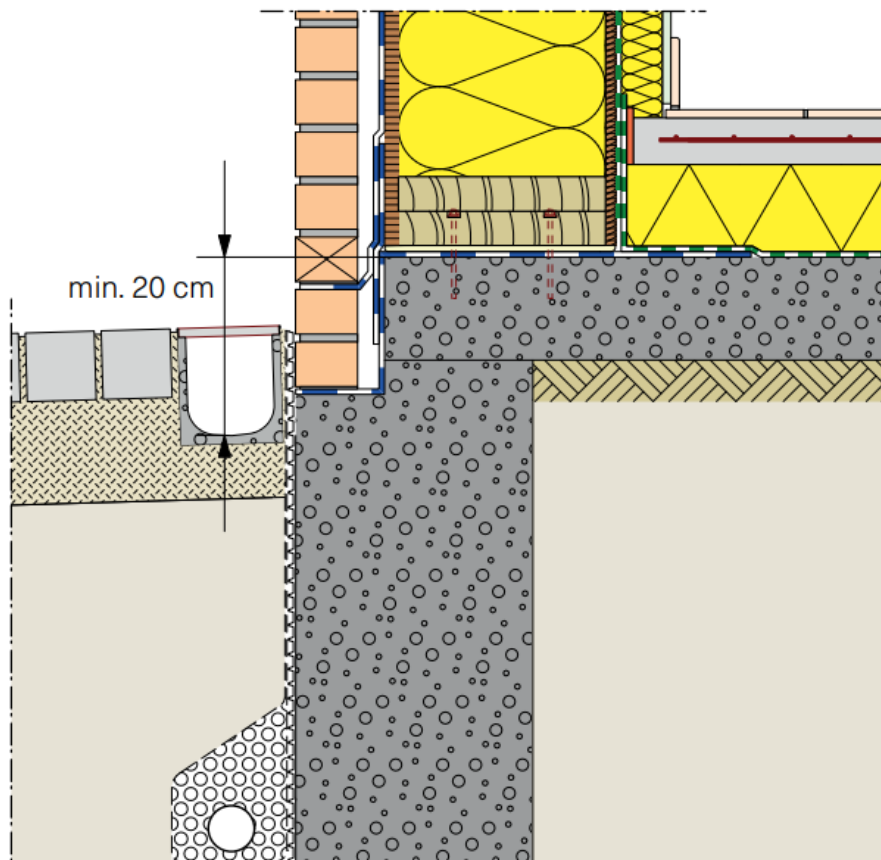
Détail du pied de mur avec hauteur réduite localement et mise en place d'un drainage effectif.
